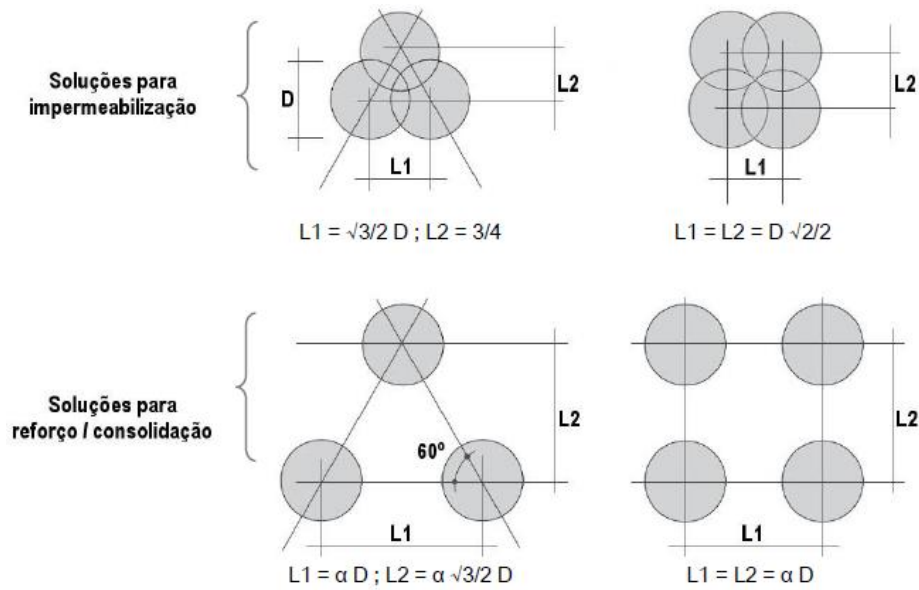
Soluções geométricas para pré-dimensionamento de *jet-grouting* (Fonte: SANTOS, 2014, p. 49 *apud* PINTO, 2009).
